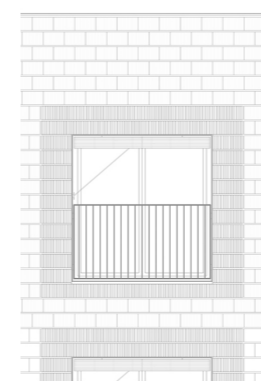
Protección de fachadas y cubiertas contra el agua.
